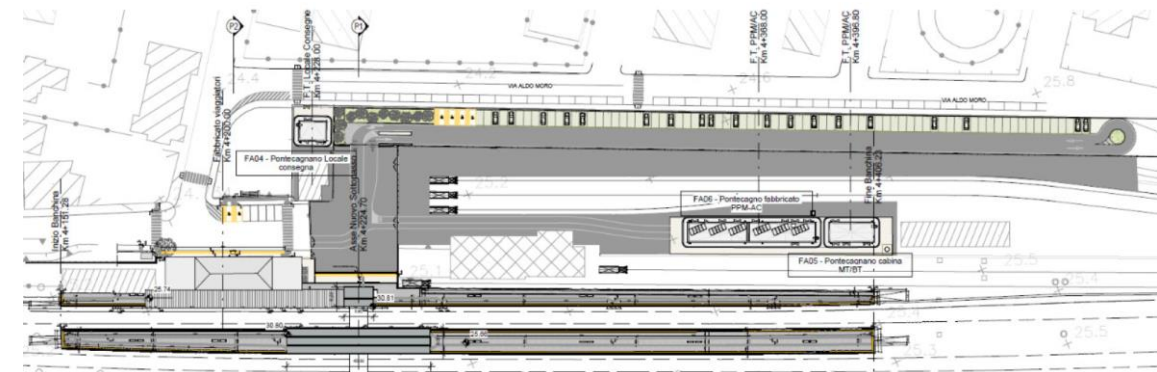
Planimetria generale della Stazione di Pontecagnano
